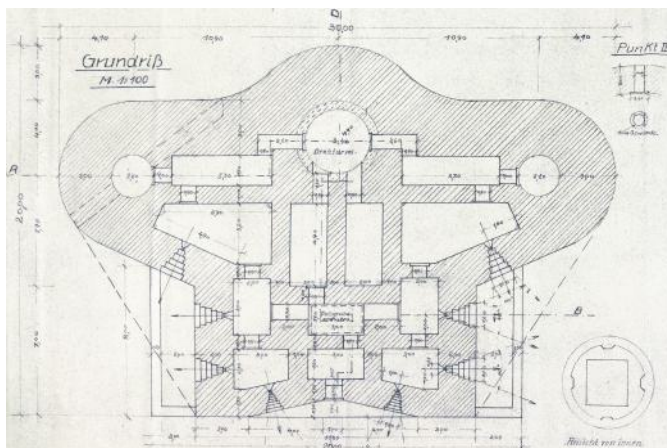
Grundriss aus den „Ausführungsrichtlinien für den Bau der Behelfsanlagen in Jüterbog“ vom Februar 1938 (BArch, RH 12-5/57b K-9).
